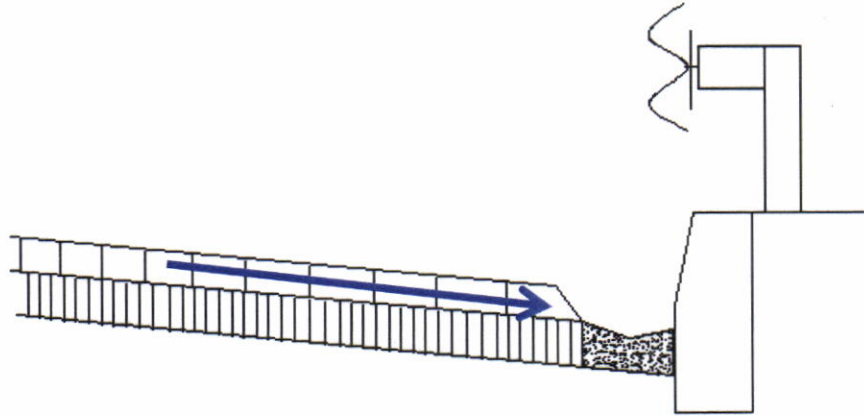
Схема отвода воды с устройством водоотводных лотков. Открытый железобетонный лоток, установленный в нижнем слое покрытия
